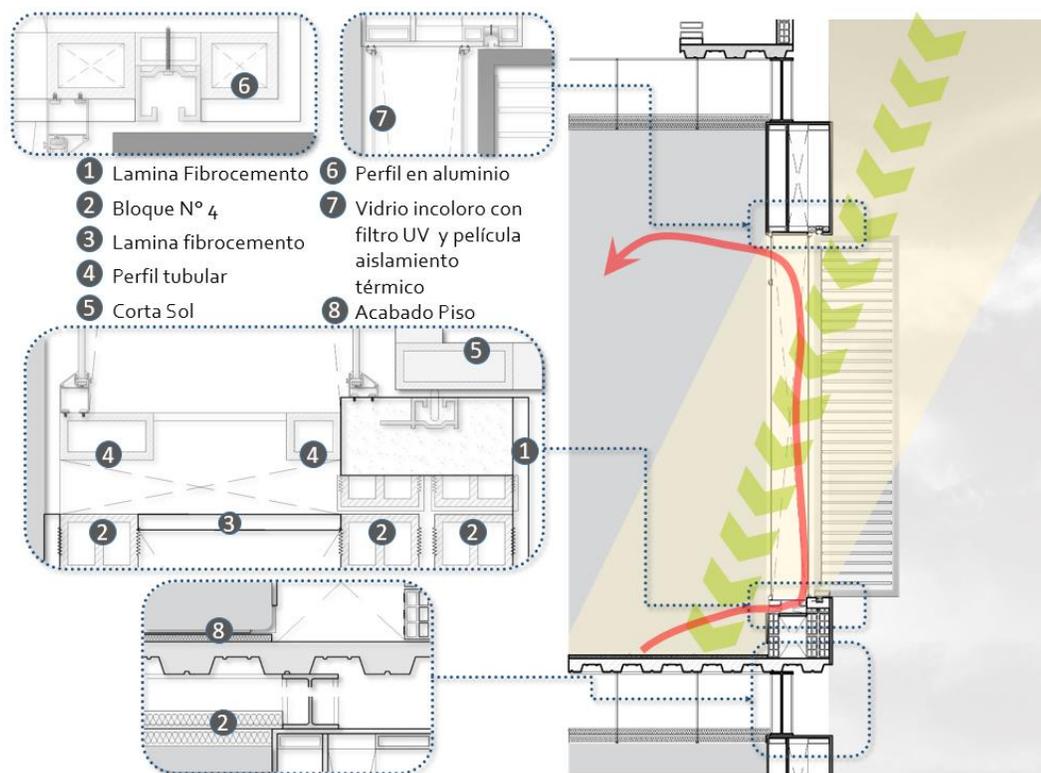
Corte fachada y detalles correspondientes a materialidad en clima cálido (ver anexo – “Detalle corte fachada”)
